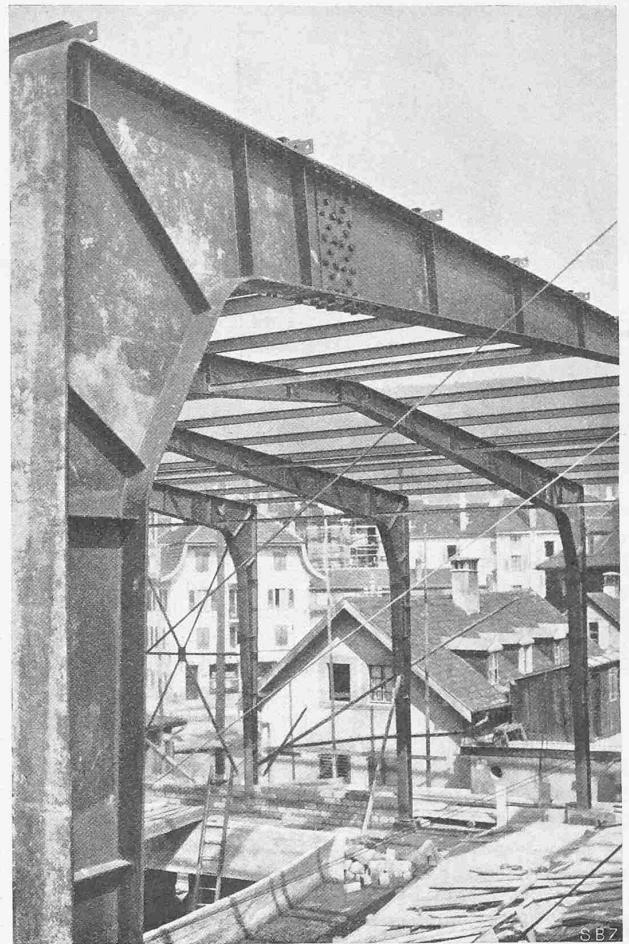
Detailansicht des völlig aus Flacheisen, Breitflacheisen und Blechen zusammengeschweissten Hallenbinders.
